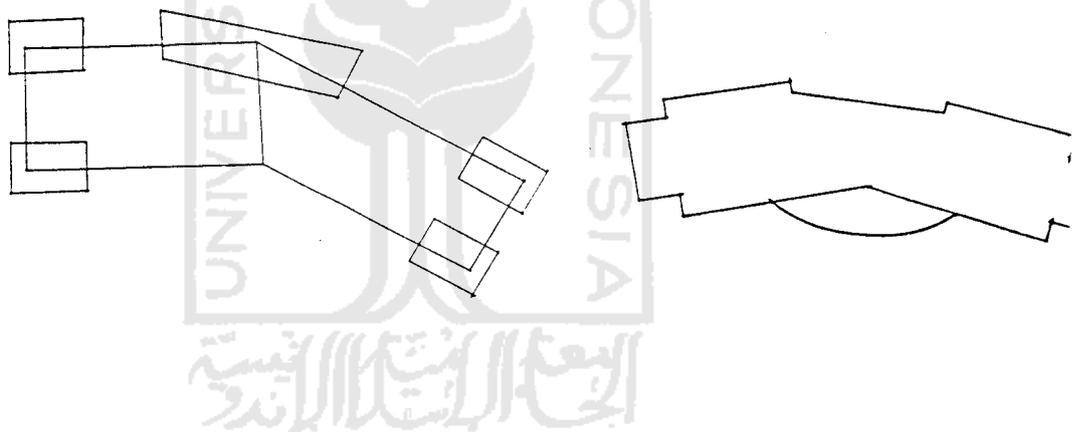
Pengembangan Massa Lantai Vertikal
